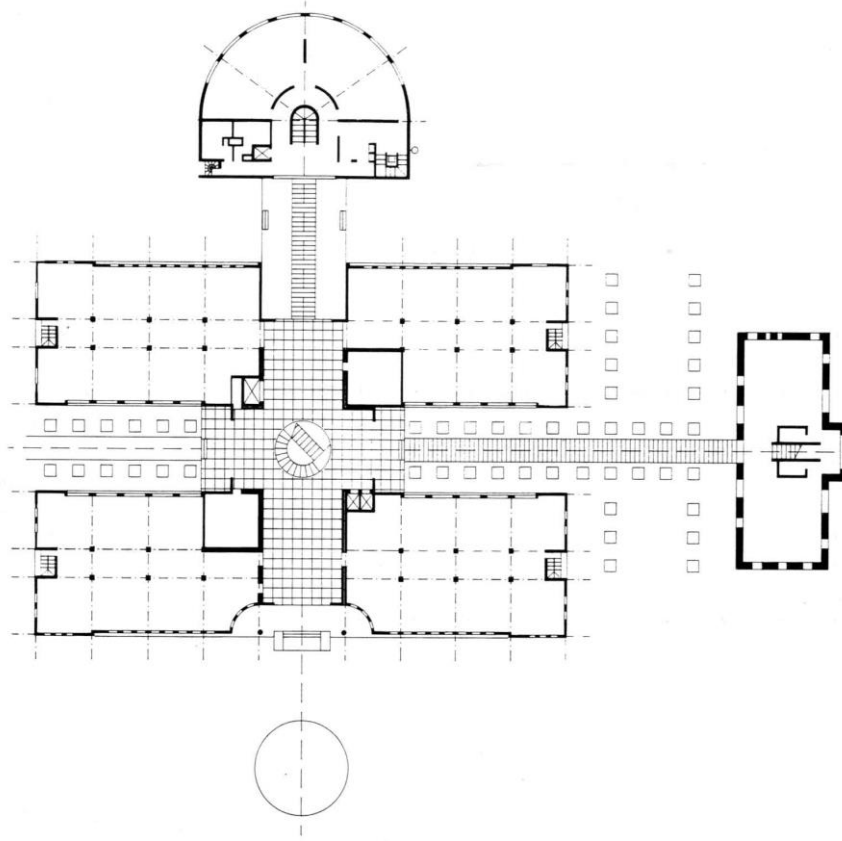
Doğan Medya Center, plan (Anonim 1994).
